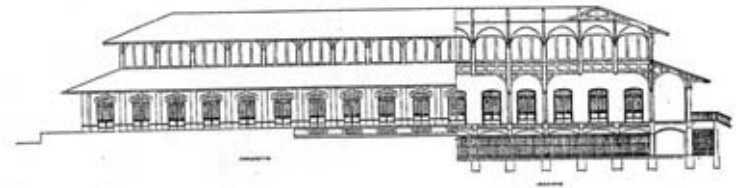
Padiglione per la vendita degli abbacchi, polli, ova, etc. (Prospetto e sezione longitudinali).
